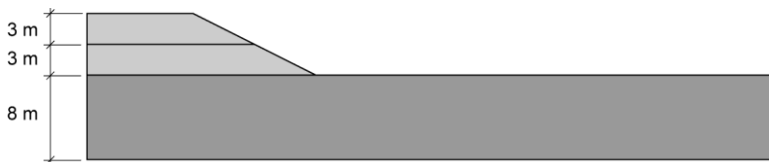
Schéma du remblai et de la couche d'argile (demi-coupe)
